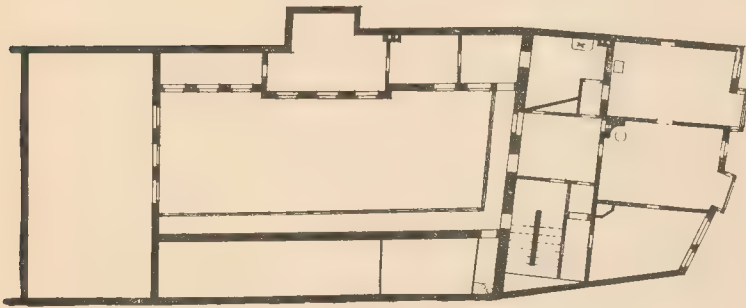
Haus D284. Grundriß des Hauptgeschosses.
